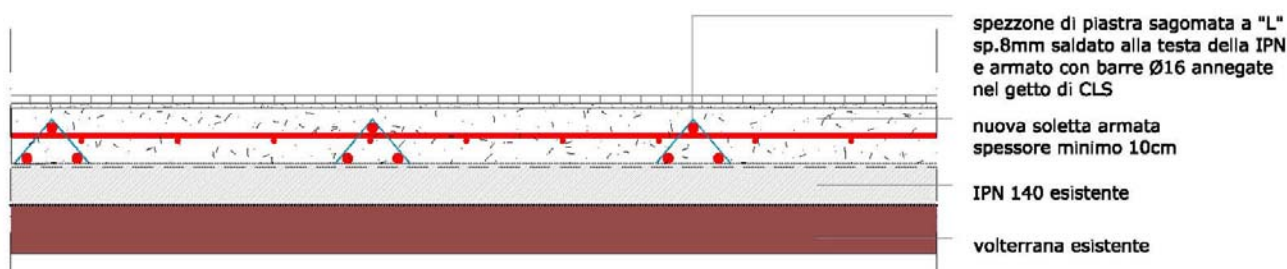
Sezione longitudinale di un solaio del piano terra allo stato di progetto.
